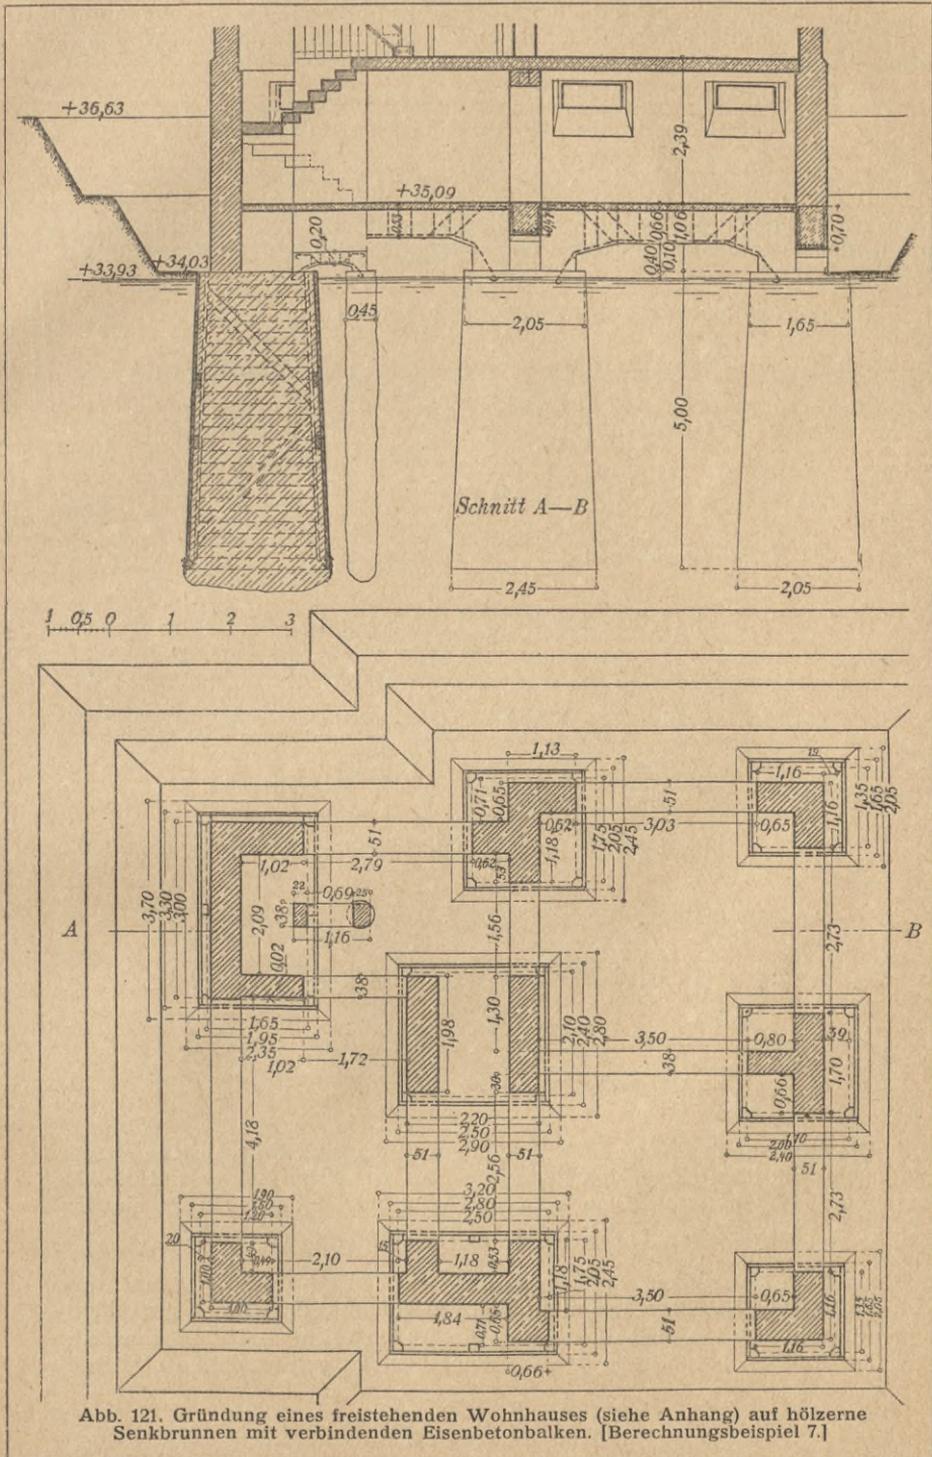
Gründung eines freistehenden Wohnhauses (siehe Anhang) auf hölzerne Senkbrunnen mit verbindenden Eisenbetonbalken. [Berechnungsbeispiel 7.]
